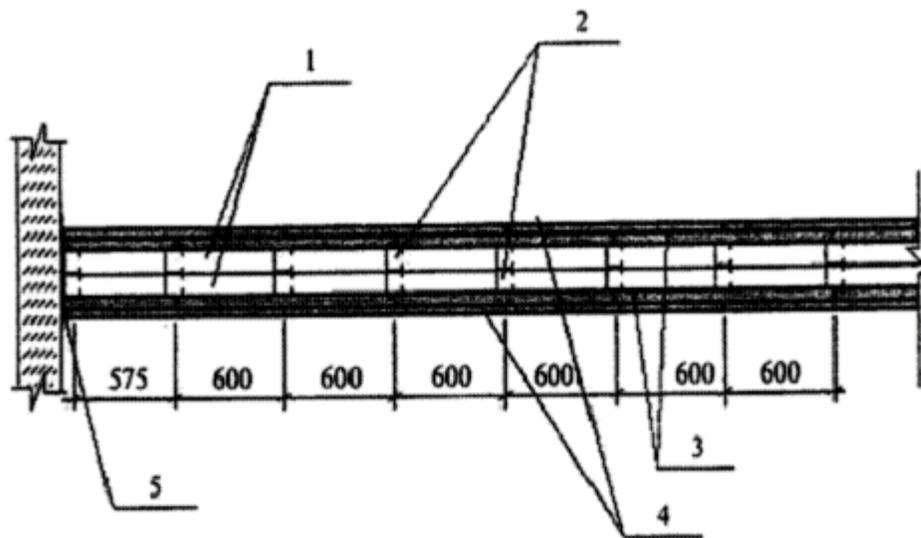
Схема монтажа элементов двойного каркаса и облицовки из ГКЛ перегородки С 115.1
